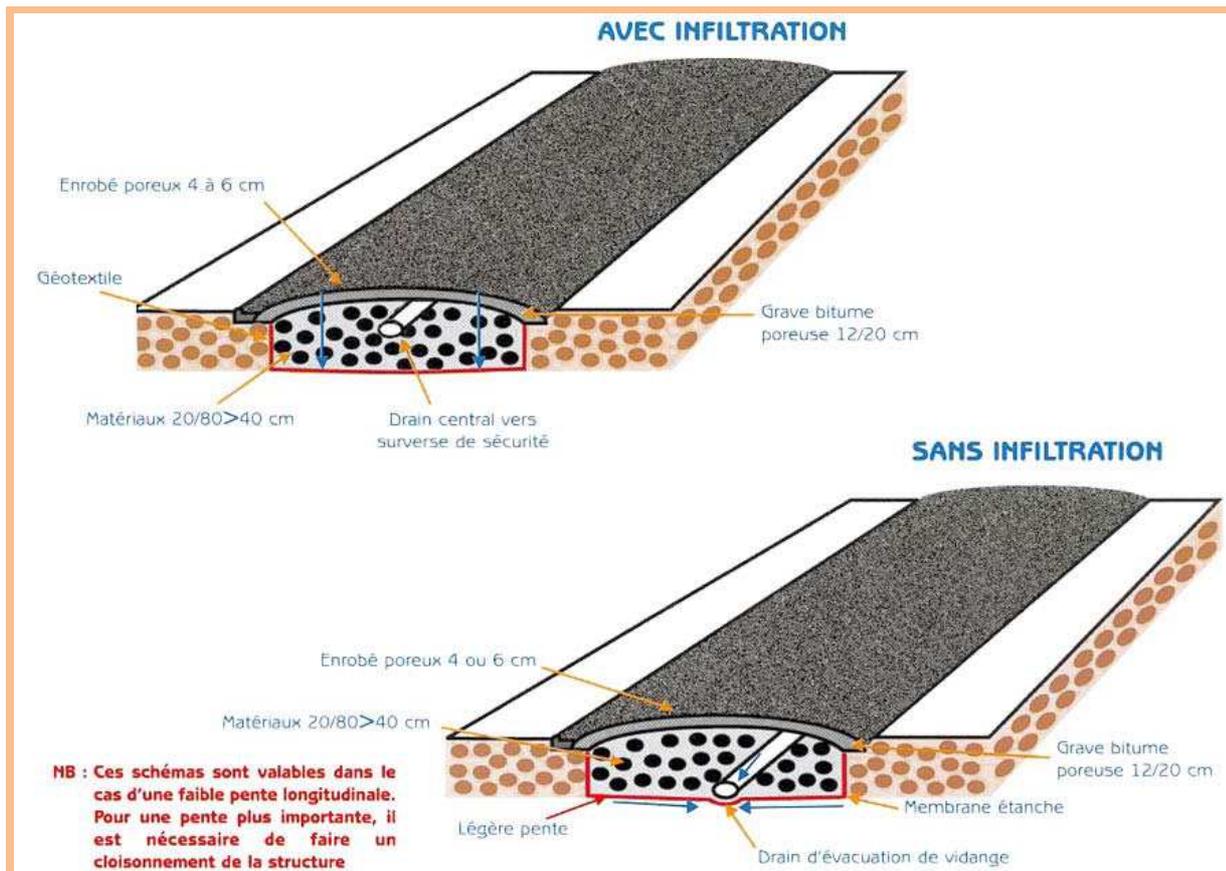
Coupe transversale d'une chaussée à structure réservoir avec revêtement drainant (Injection répartie)¹
